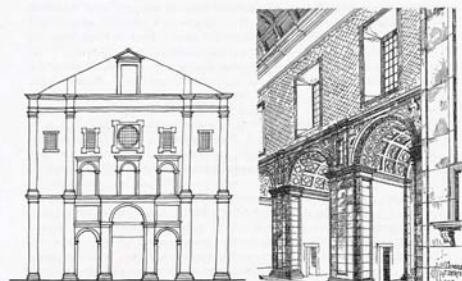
Coimbra, S. Bento. Fachada (segundo Haupt).
